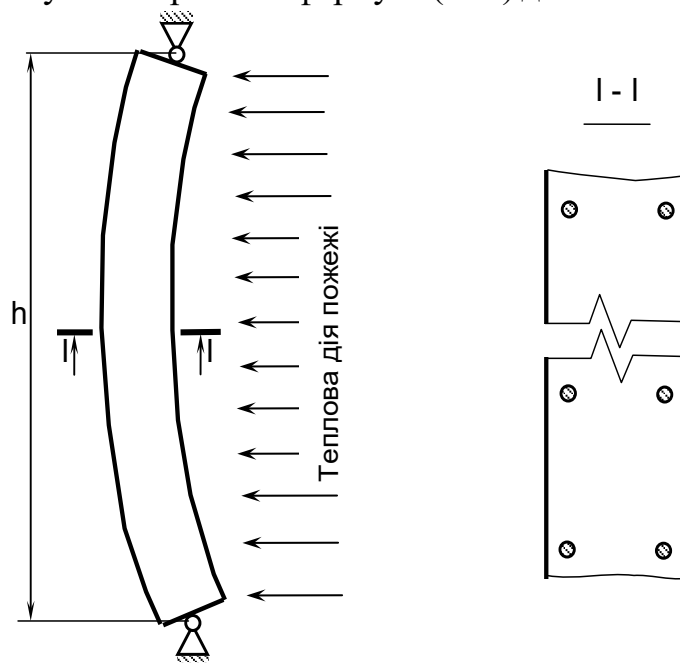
Розрахункова схема силікатобетонної армованої стіни
